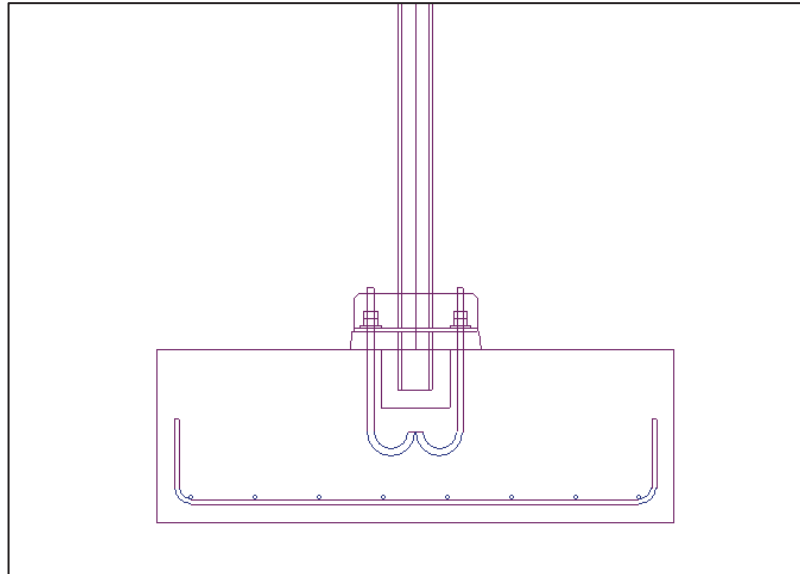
Detalle de las zapatas de los pórticos hastiales de los lazaretos.
